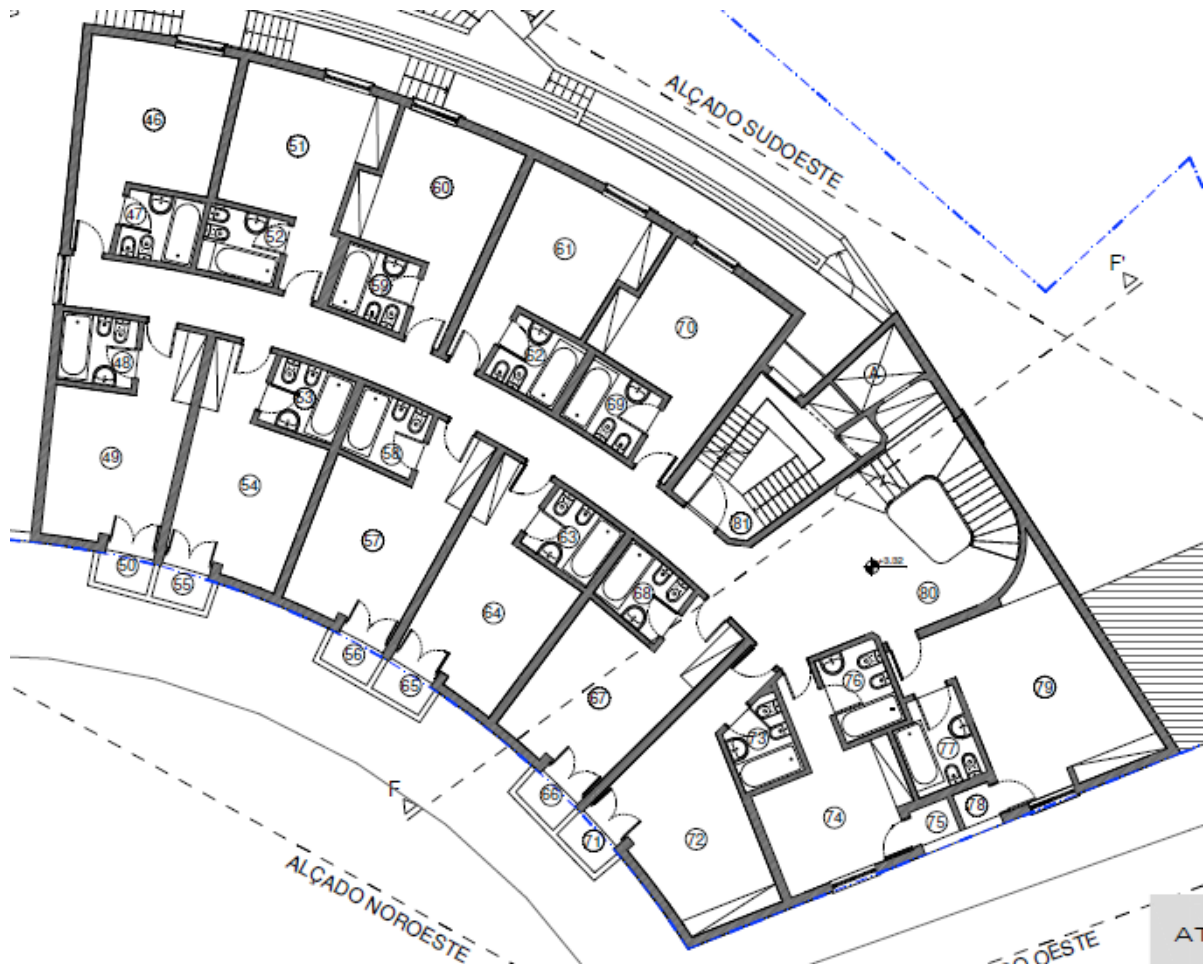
Planta do piso 1- Edifício existente [Atelier B2, 2016]
